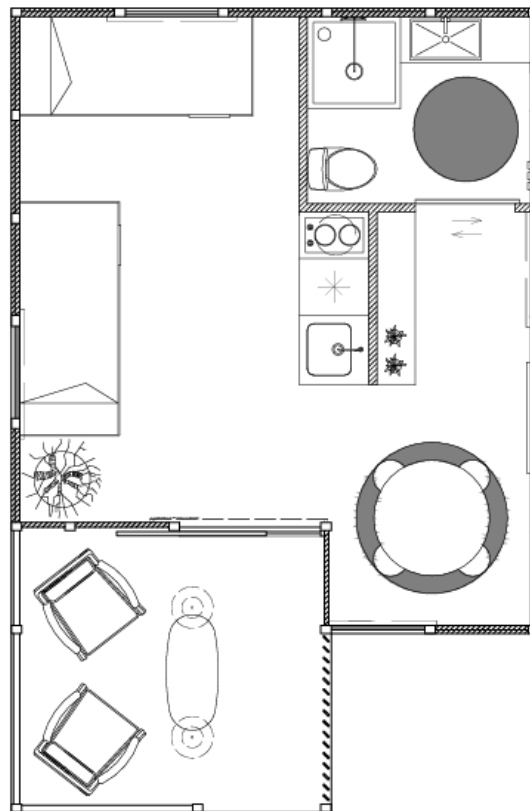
Planta final - Bungalow 2 (Fonte: autora)
